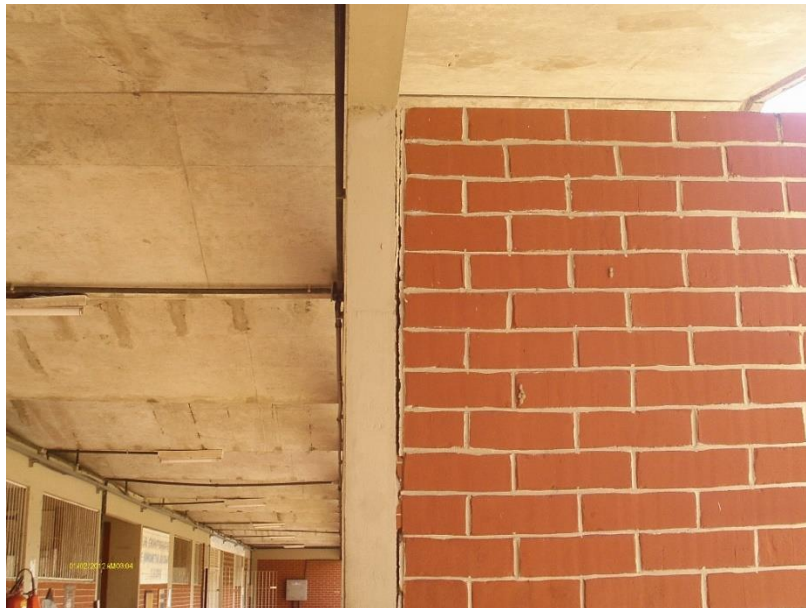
Fissura entre pilar e quebra-sol. Notar que a abertura é tão grande que é possível ver outro painel de alvenaria através da fissura.
